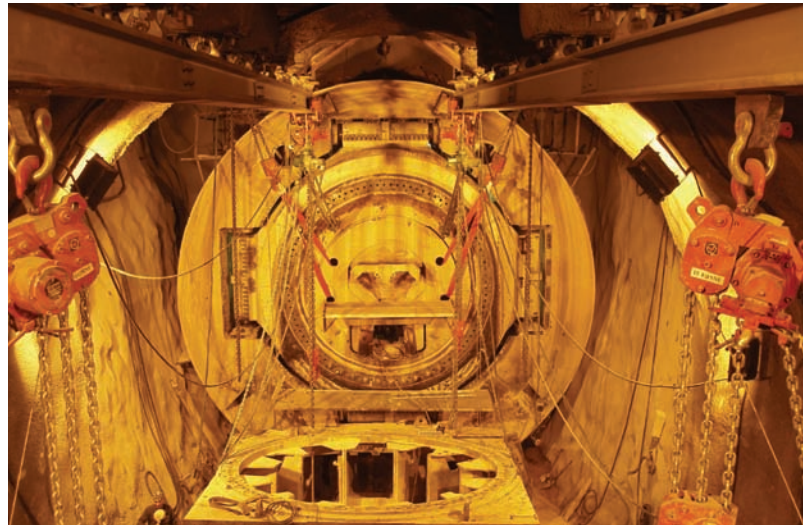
Detalle de caverna, estructura metálica y colocación de polipastos.
